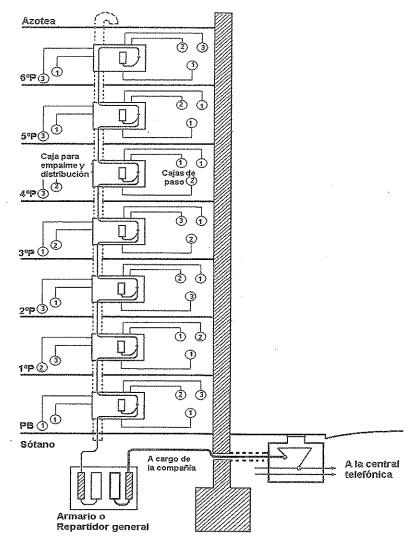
X. Diagrama esquemático instalación interna de un edificio
